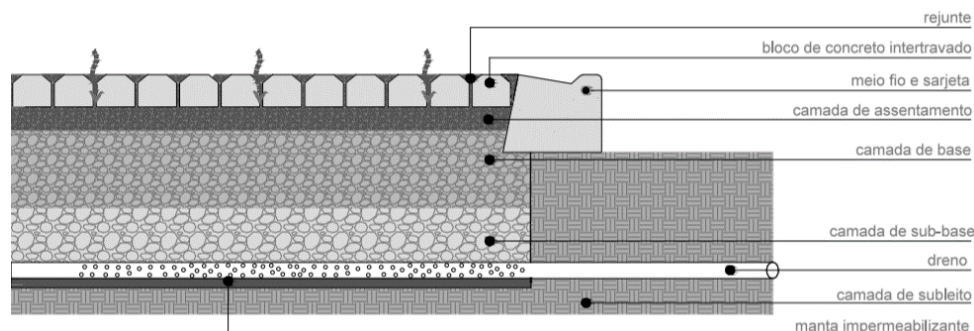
Pavimento intertravado permeável sem infiltração no solo (ABCP, 2015).
